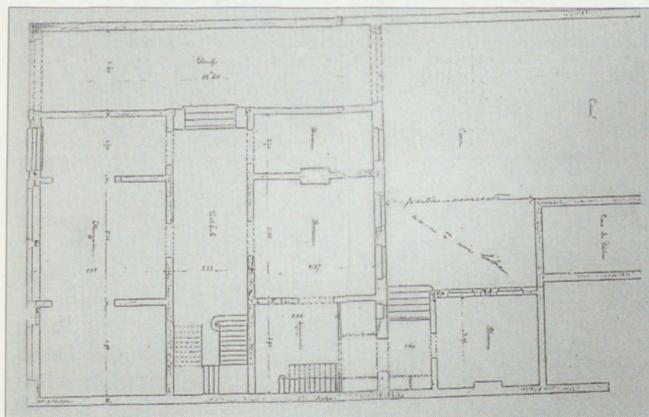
C – Liège, rue de l'Université, 38. Plan du rez de chaussée, 1900. 34 x 56 (AVL).
